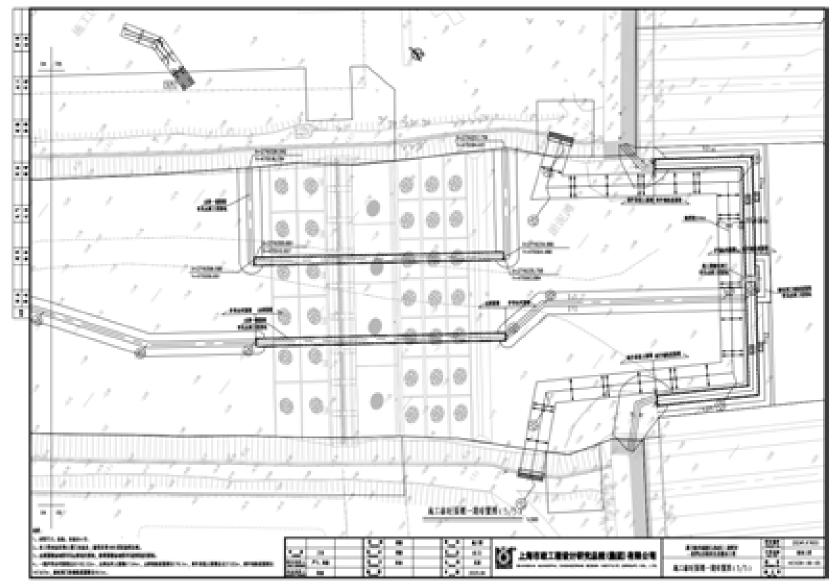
入海口钢围堰和钢便桥平面图 (一期)
